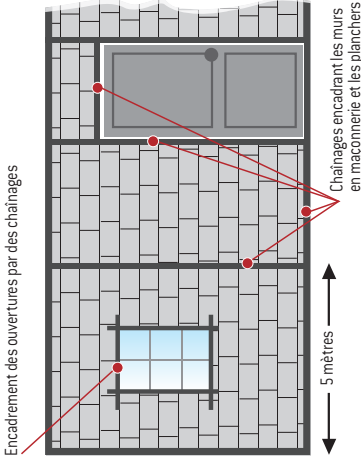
Ajout de chaînages horizontaux et verticaux encadrant les maçonneries (élévation)
